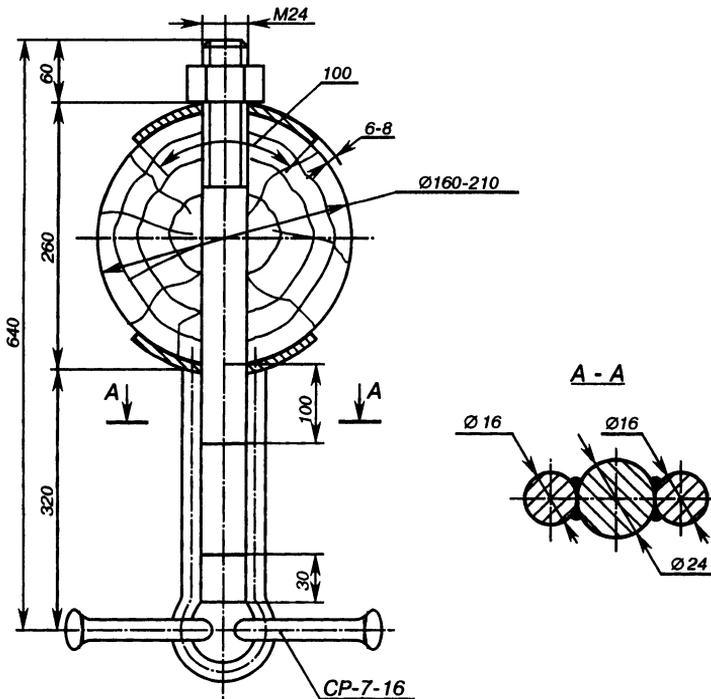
Кронштейн для крепления подвесных изоляторов на угловых промежуточных деревянных опорах ВЛ 6–10 кВ
